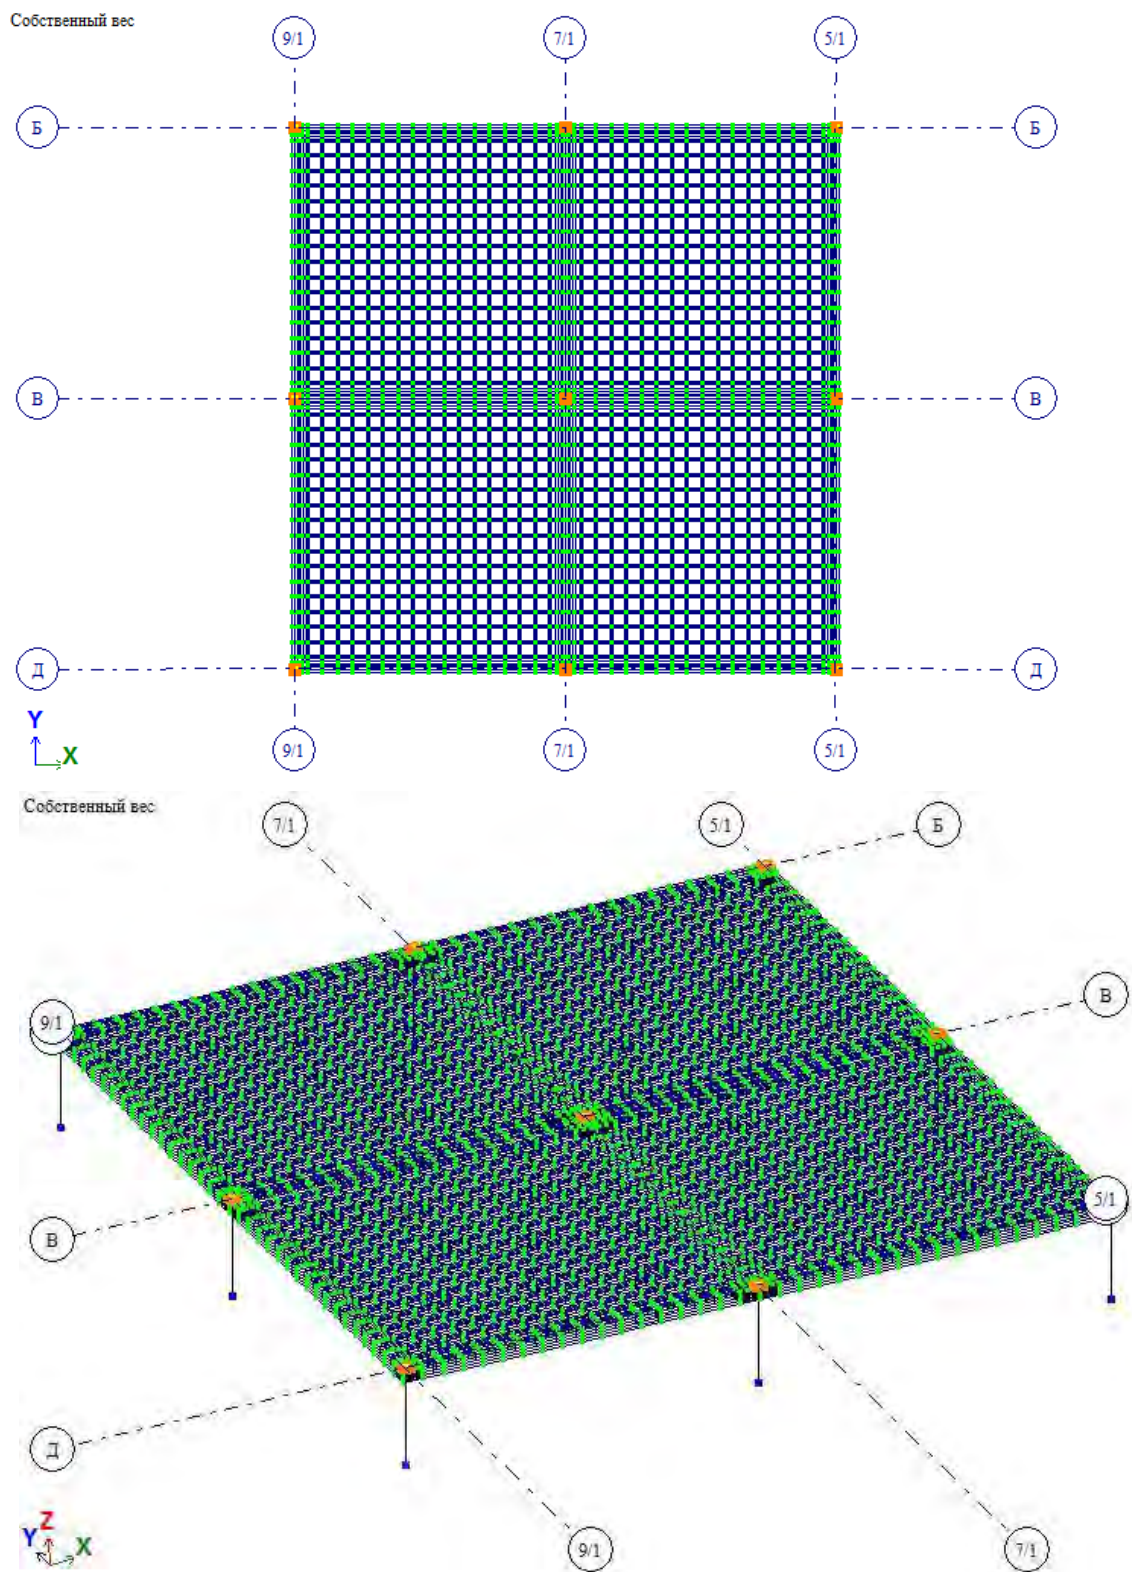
Разбивка плиты перекрытия на конечные элементы
